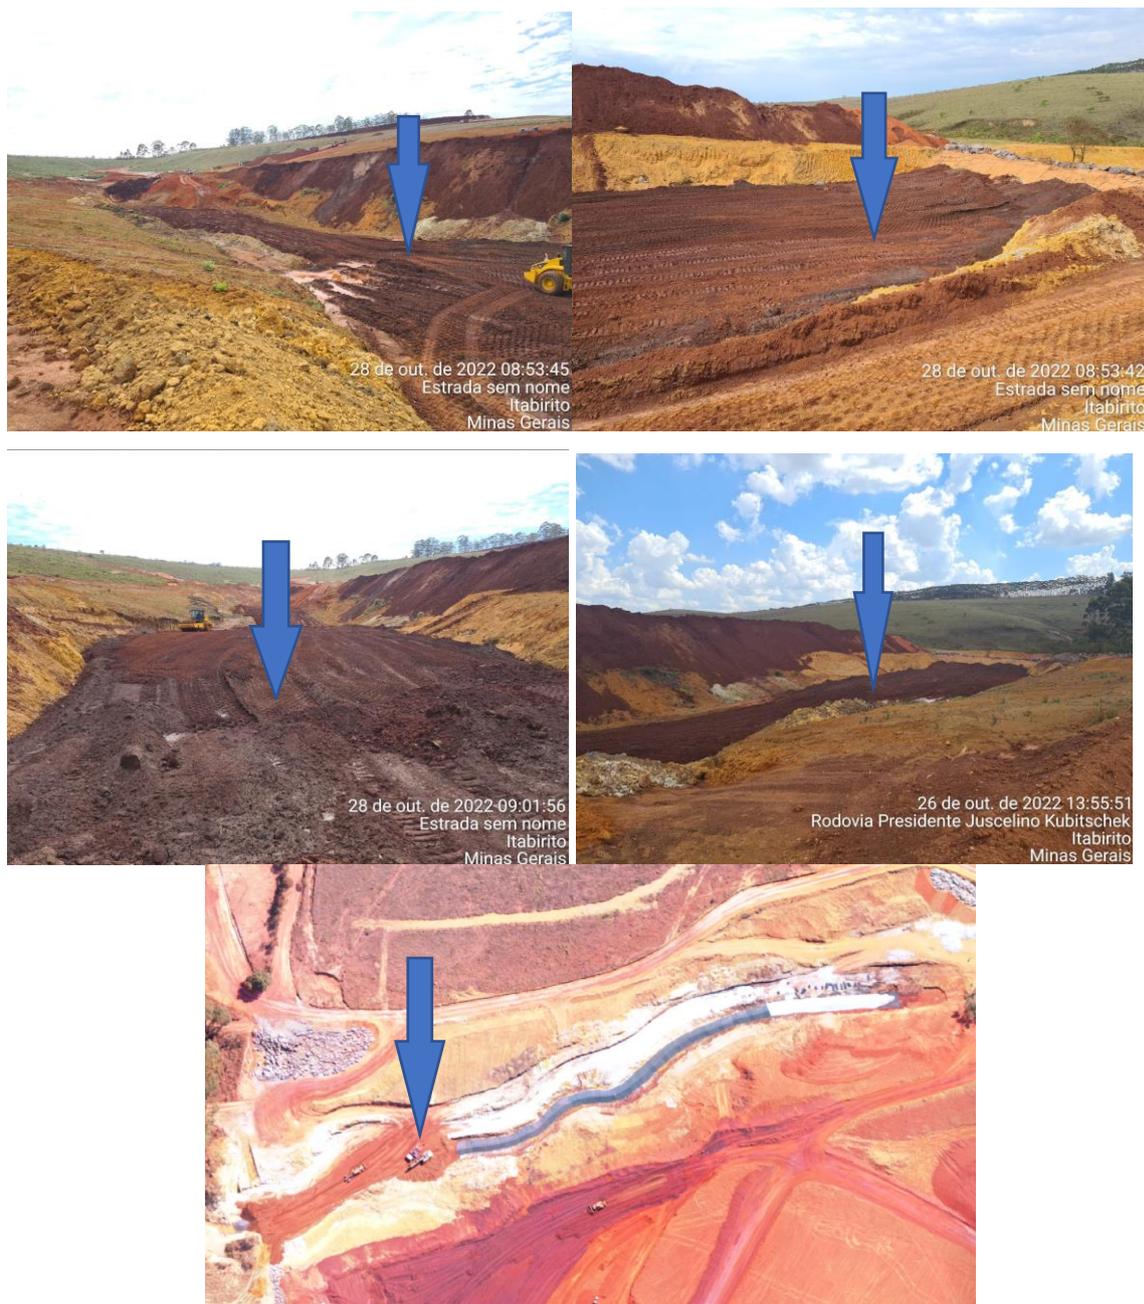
Rejeito grosso (indicado por seta azul) sendo espalhado e compactado por rolo na pilha noroeste.
